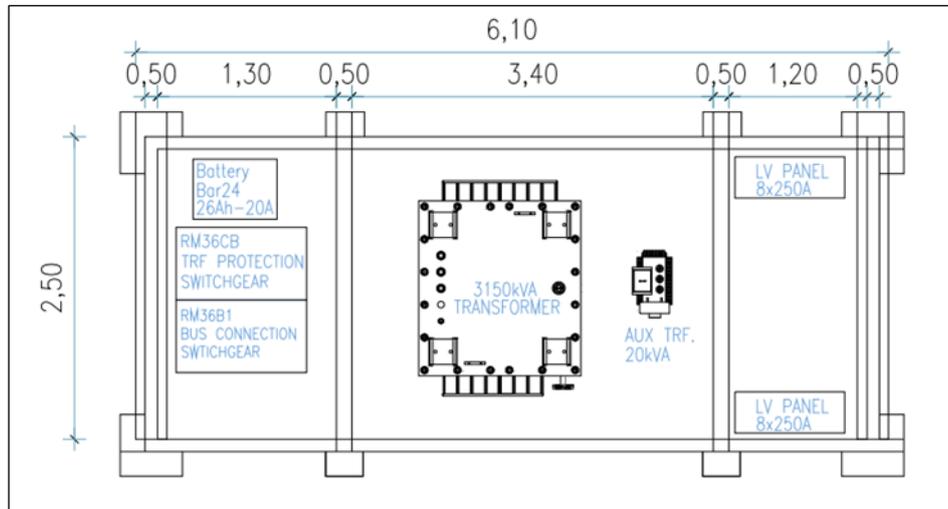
Planimetria (esempio) cabina di Trasformazione (cabina di campo) – vista in pianta
